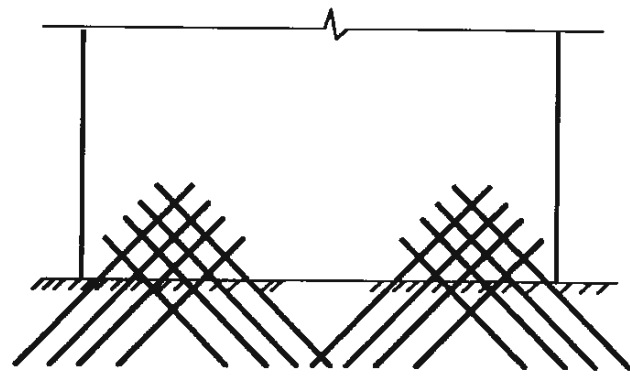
框支层的落地双肢剪力墙根部斜筋构造
